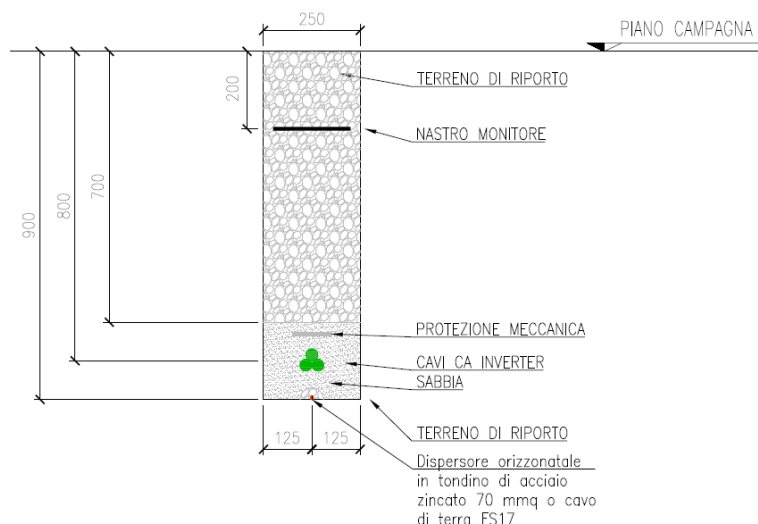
Sezione tipologica cavidotto con cavo direttamente interrato
